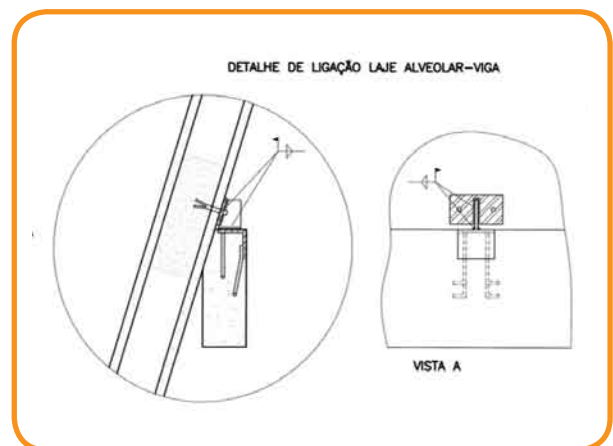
Topo da ligação das lajes alveolares. Os alvéolos foram preenchidos neste trecho. Empregaram-se chumbadores mecânicos e chapas soldadas ligadas a um “INSERT”, previamente deixado na viga.
